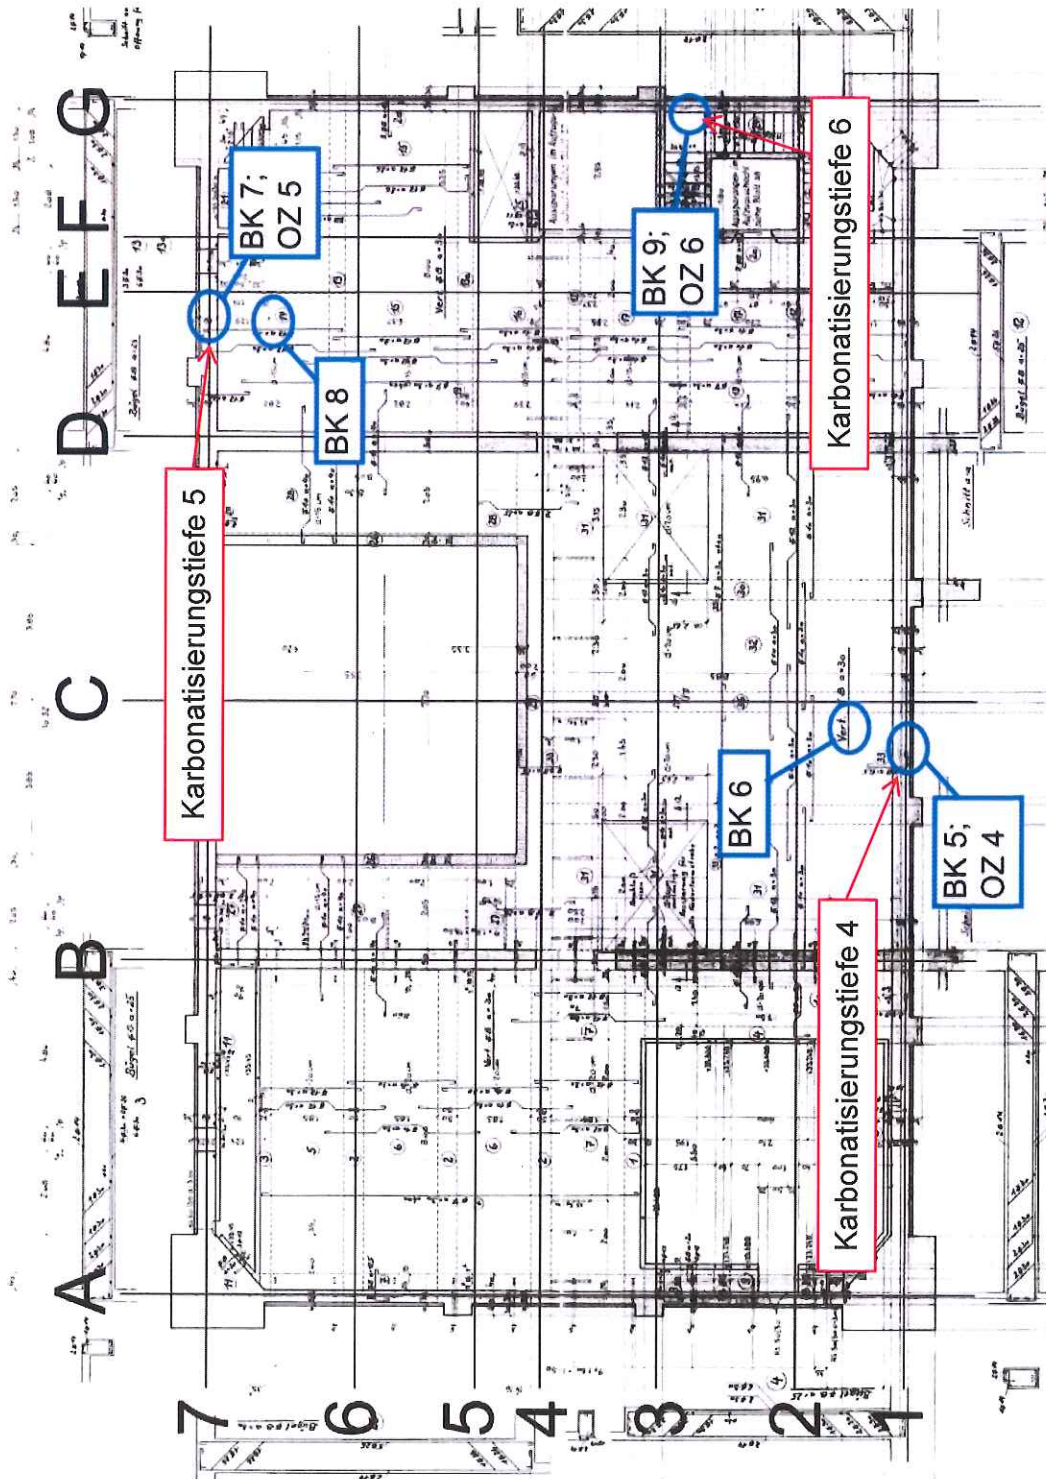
Grundriss Bühne 6 mit Entnahmestellen
